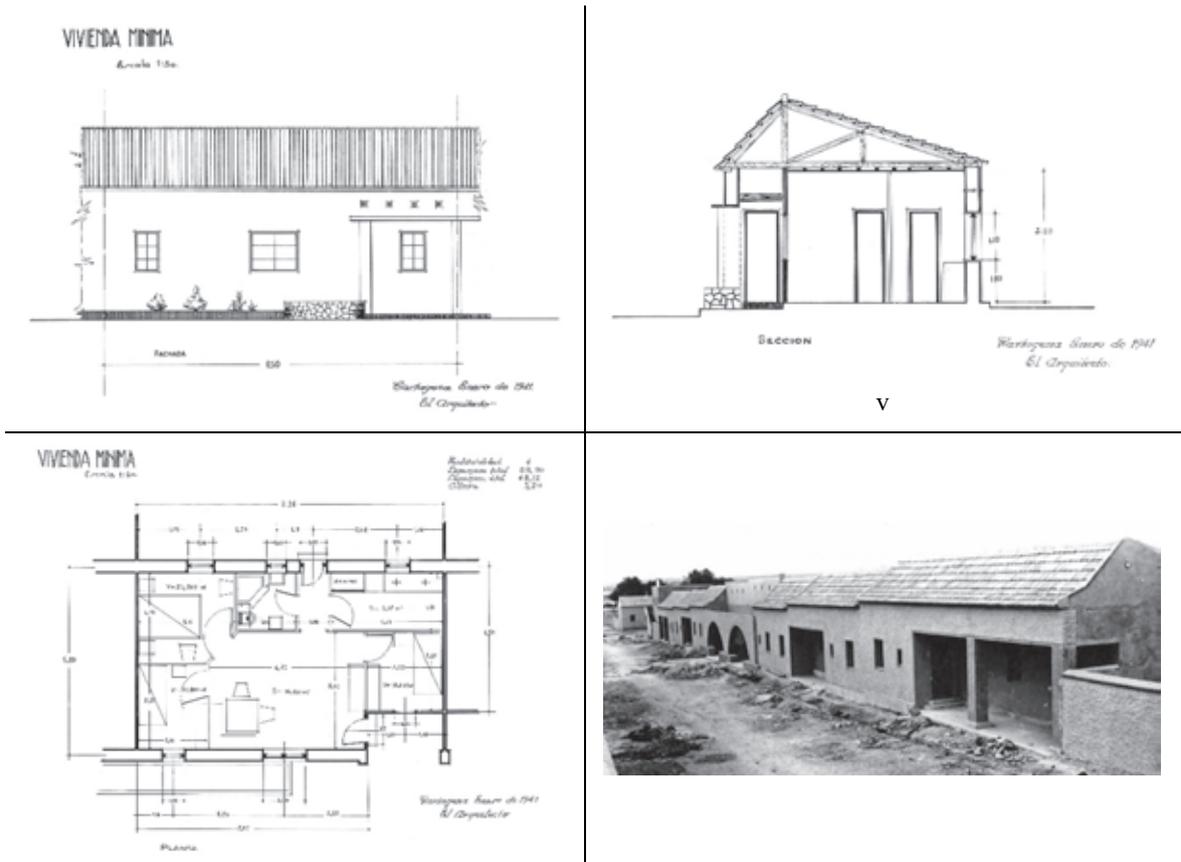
Planos de proyecto de «Los Cuatro Santos» en Cartagena y fotografía de la barriada obrera en obras. Fuente: Archivo particular de Diego Ros McDonnell
